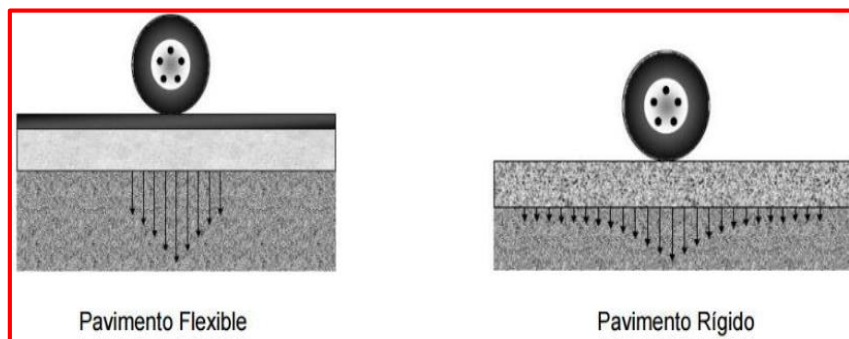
Cargas distribuidas en un pavimento flexible y rígido
